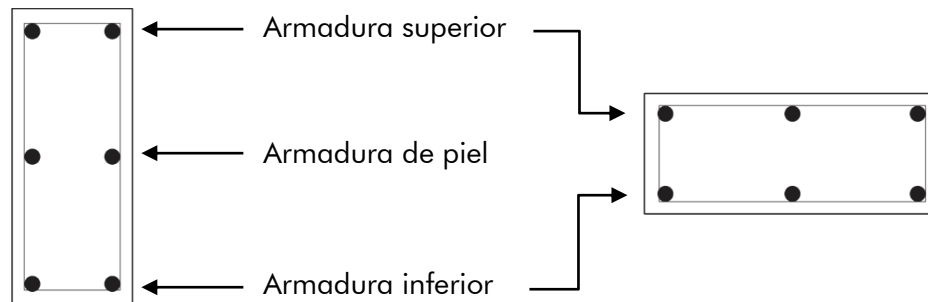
Sección transversal de vigas de H^ºA^º, con su armadura longitudinal a flexión
